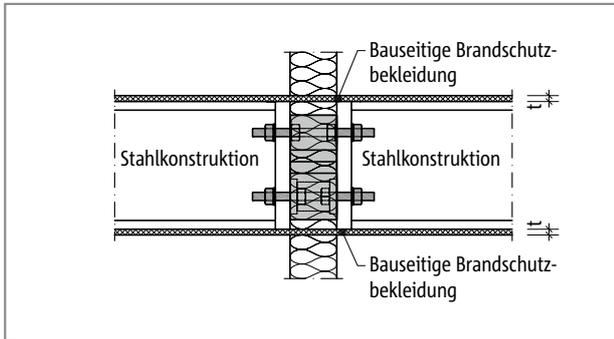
Brandschutz Schöck Isokorb® T Typ S: Bauseitige Brandschutzbekleidung bei bündigen Stirnplatten; Schnitt
